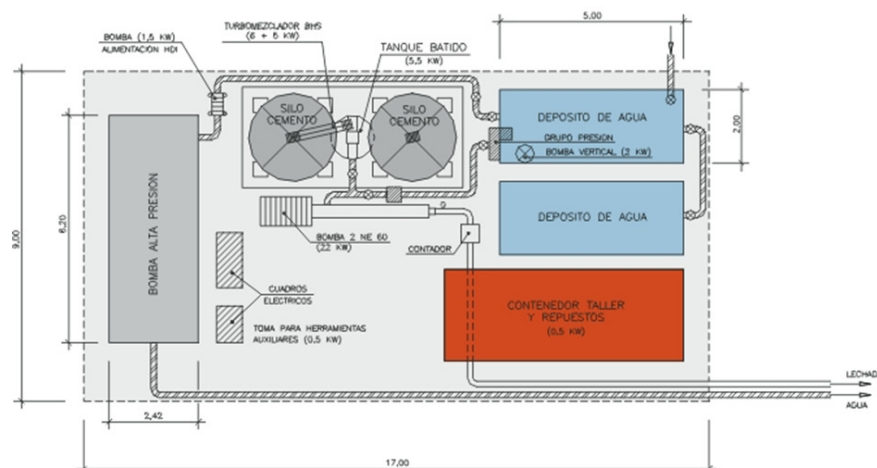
Esquema zona de montaje para el sistema de Jet Grouting.
